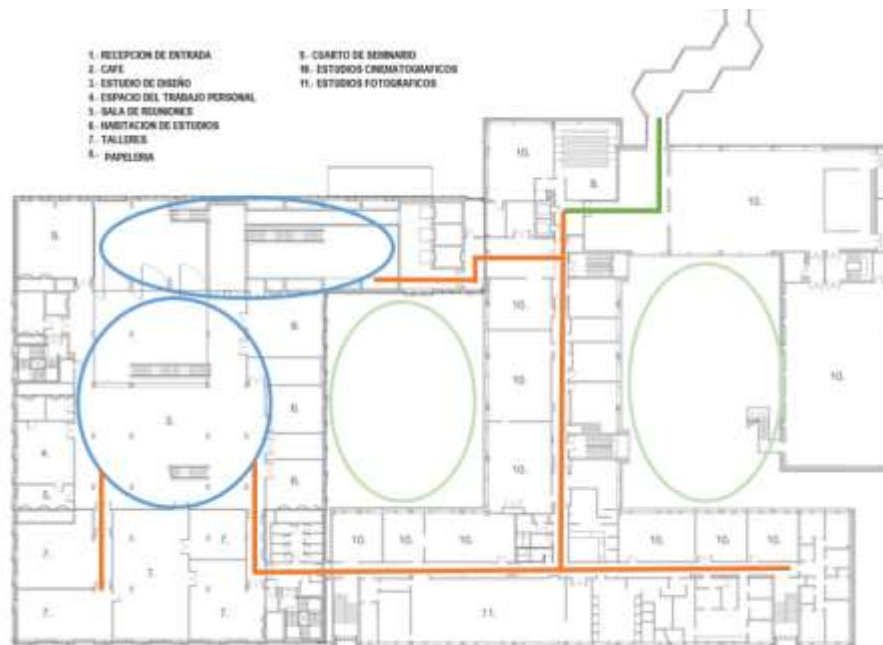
PLANTA BAJA La Escuela de las Artes
